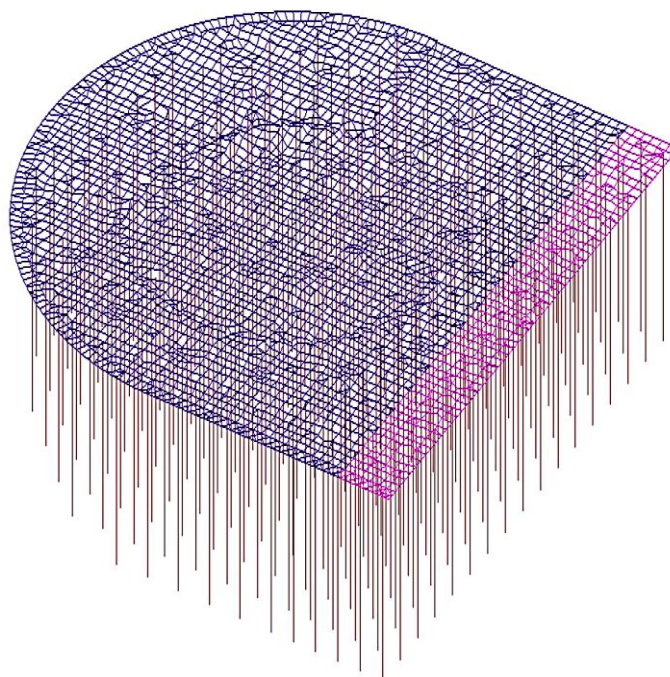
Розрахункова схема пальового фундаменту в ПК SCAD
